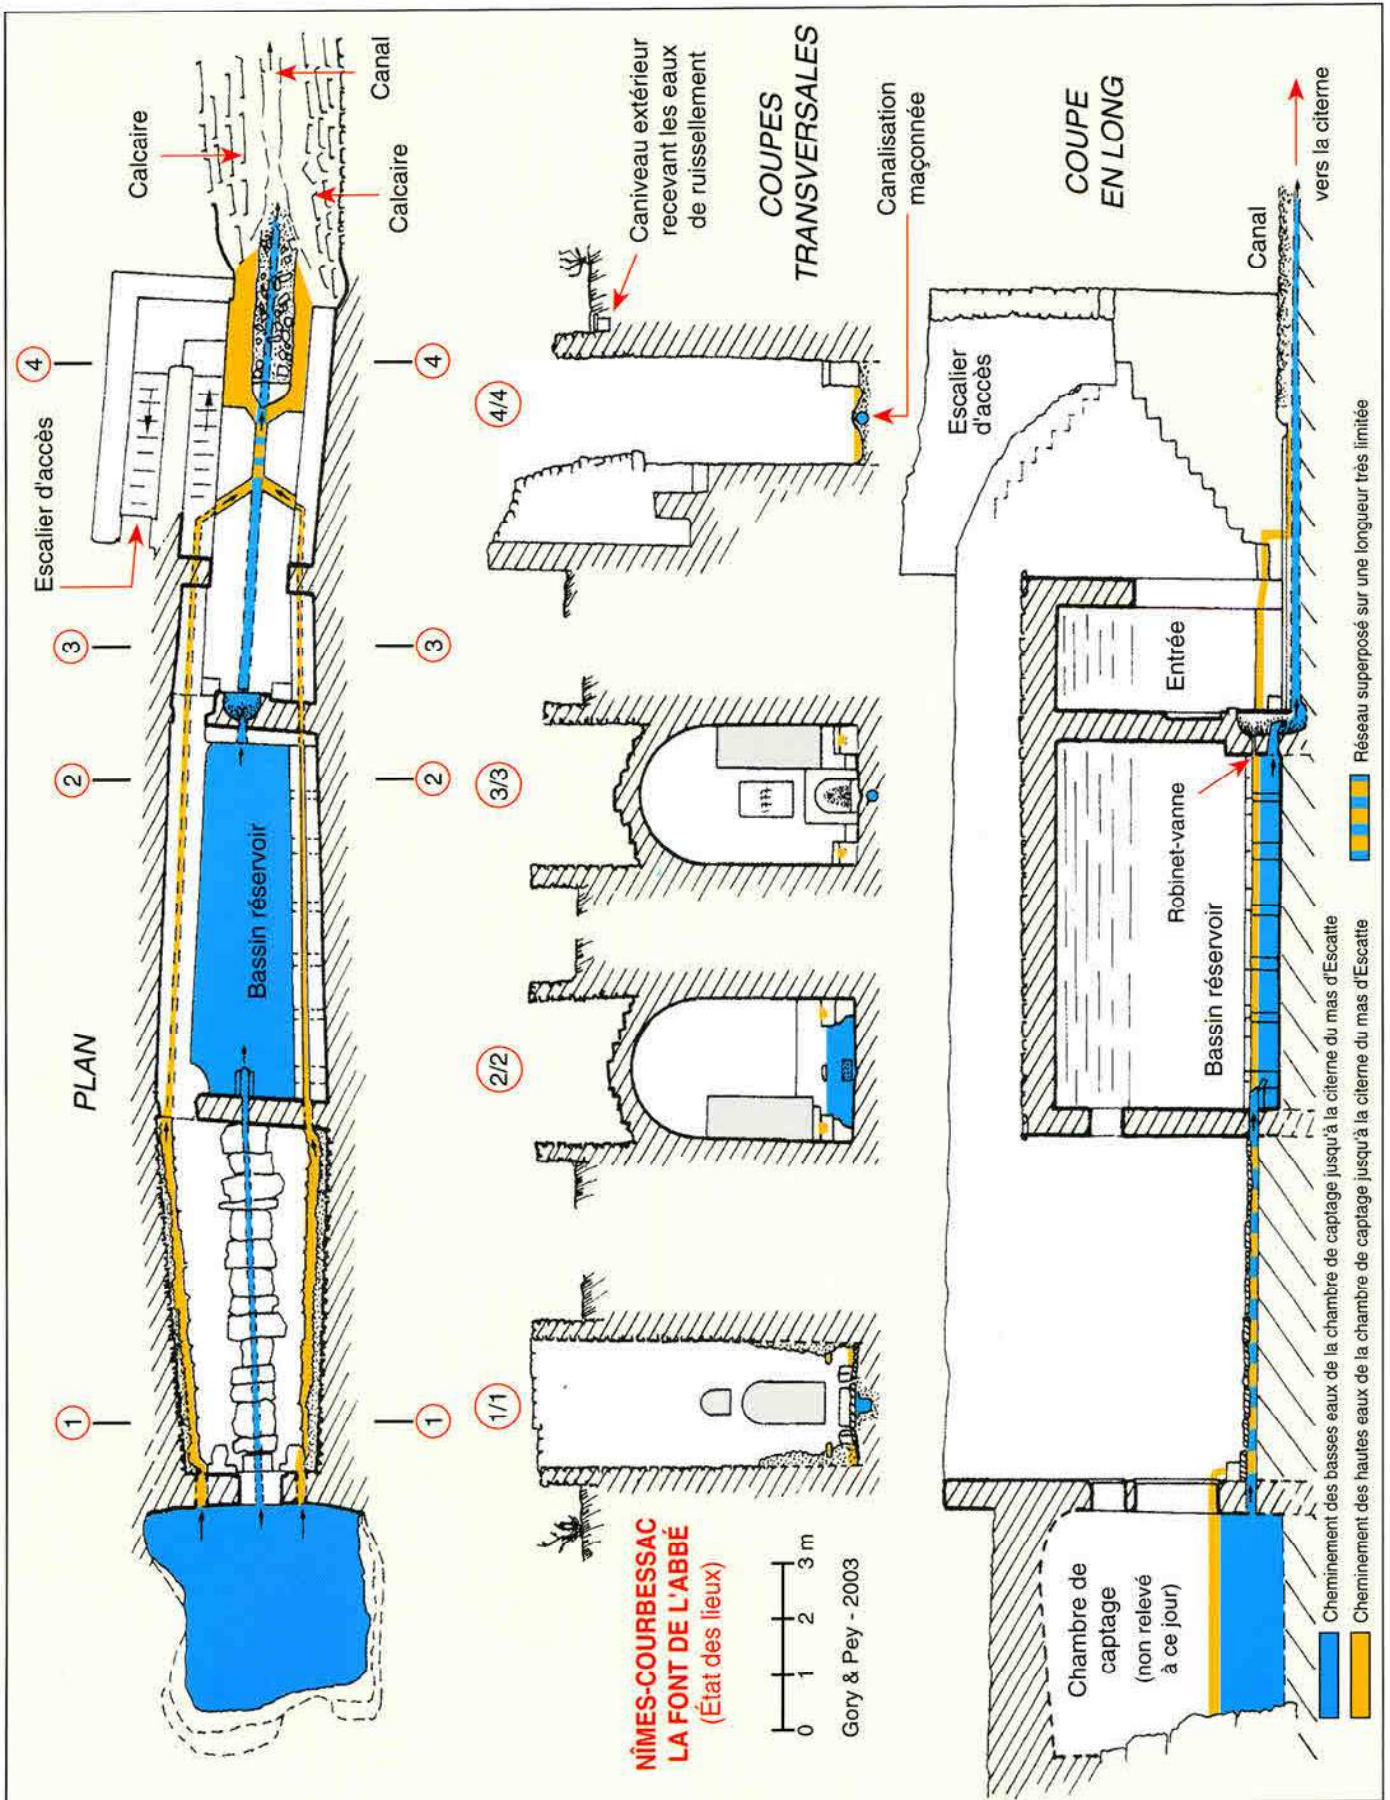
La Font de l'Abbé. Plans et coupes.
